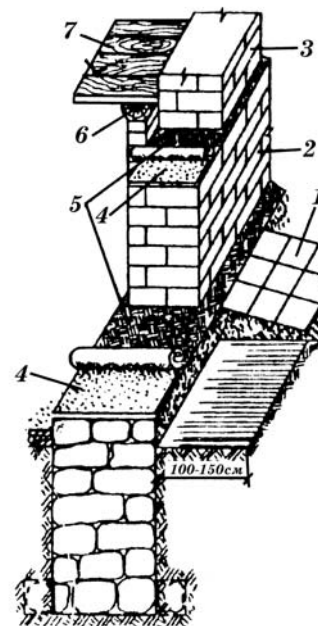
Общий вид фрагмента конструкции отмостки, стены, пола и фундамента: 1 – отмостка; 2 – цоколь; 3 – стенка; 4 – цементный раствор; 5 – гидроизоляция; 6 – лага; 7 – пол.
